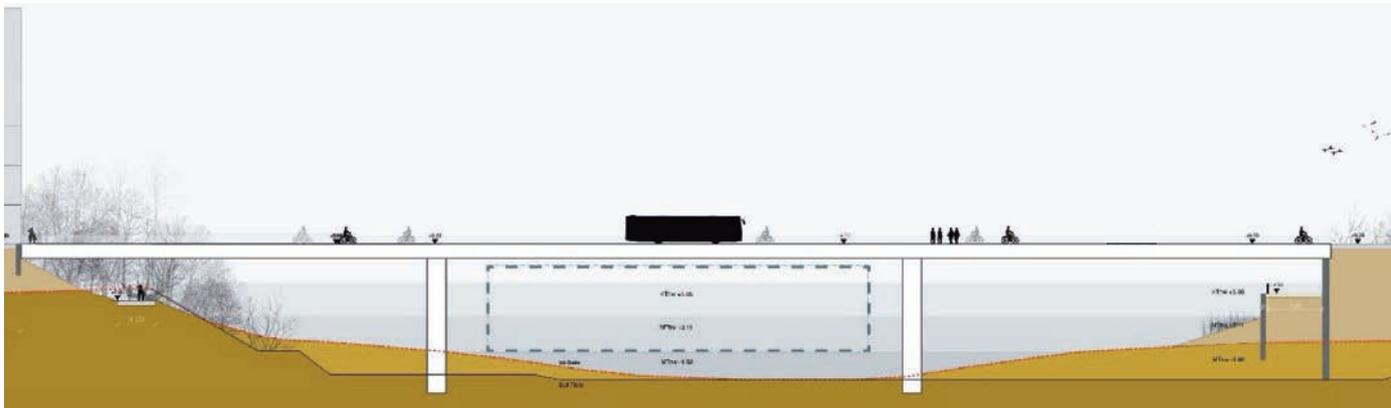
Schnitt Moldauhafenbrücke (schematisch)
